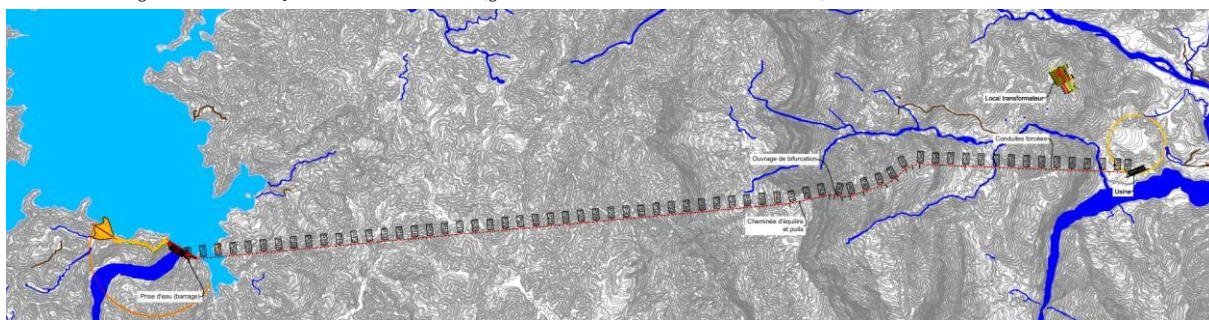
Vue en plan de la voie d'eau (galerie d'amenée et conduite forcée)
